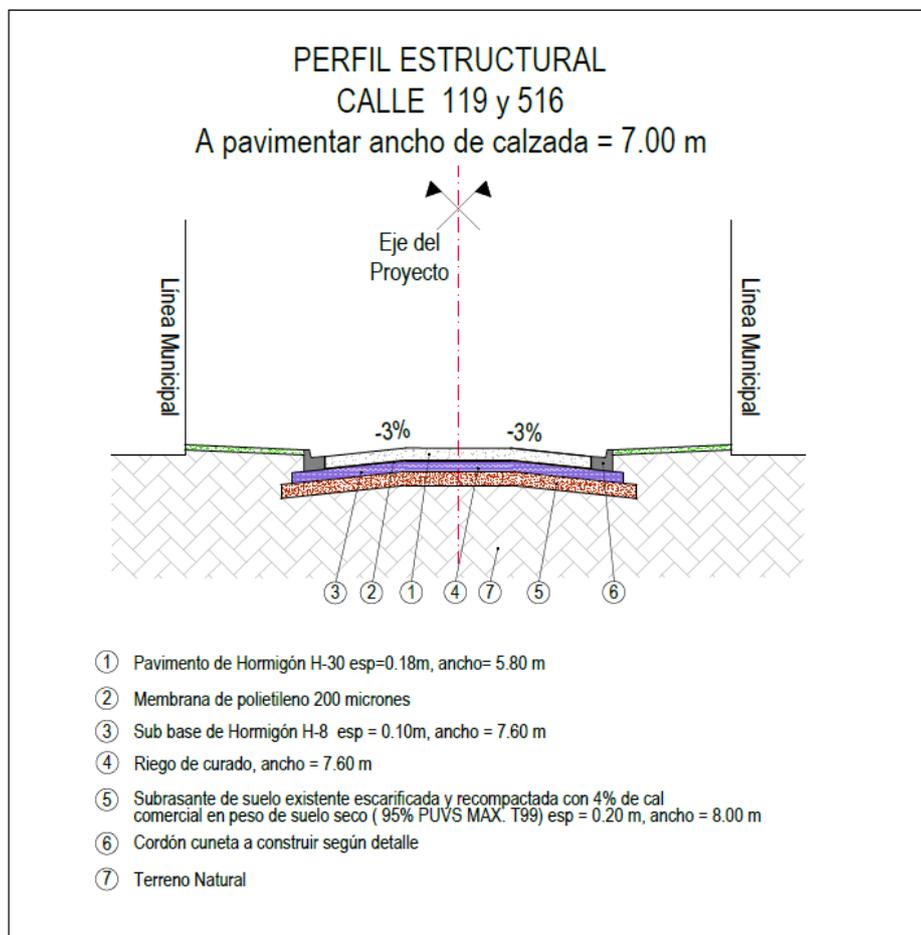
Estructura de Pavimento – Calle 119 y Calle 516
